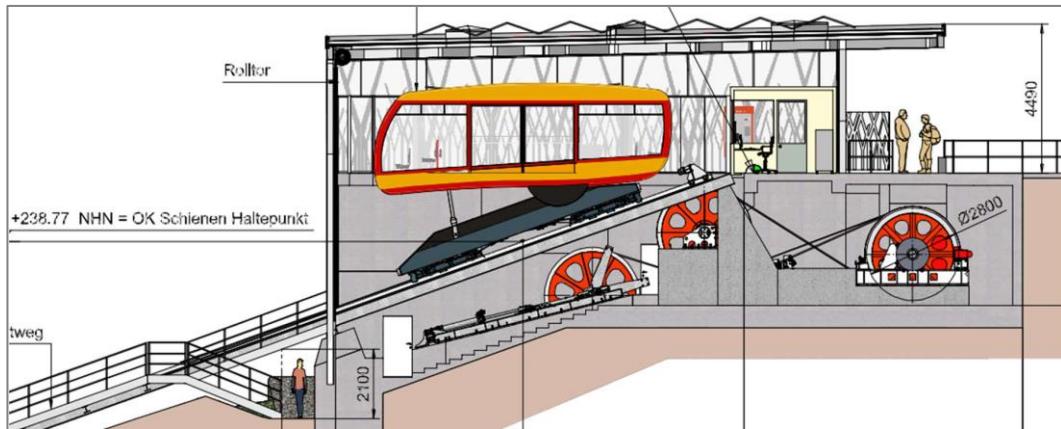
Schnitt geplante Bergstation mit ebenerdigem Ein-/Ausstieg (Quelle: Garaventa)
